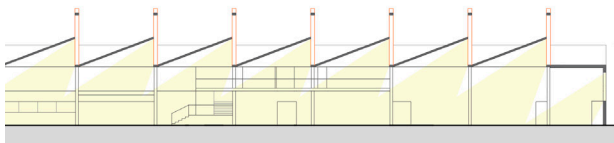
Detalle de sección longitudinal de TABSA con esquema de la entrada de la luz.
